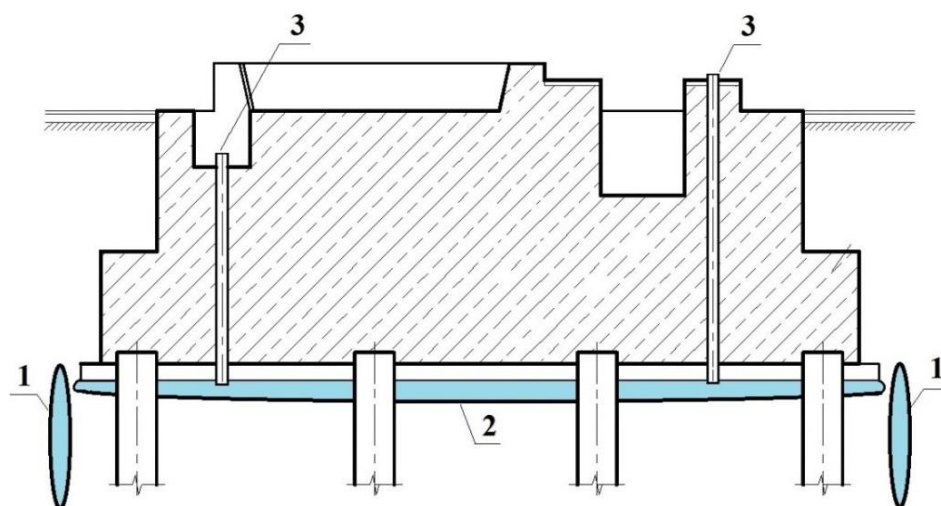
Схема усиления свайного фундамента под машину с динамическими нагрузками инъецированием раствора под подошву ростверка.
